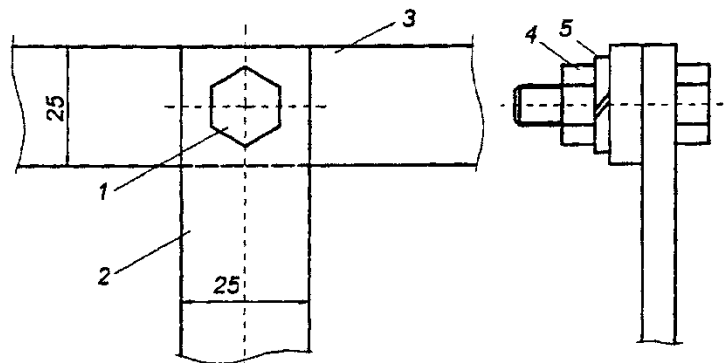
Схема присоединения заземляющего проводника из полосовой стали к заземляющему контуру или сборной заземляющей шине:
